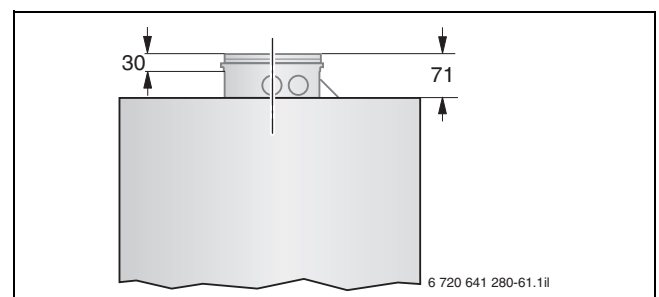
Dimensioni di montaggio del pezzo di raccordo concentrico (misure in mm)
